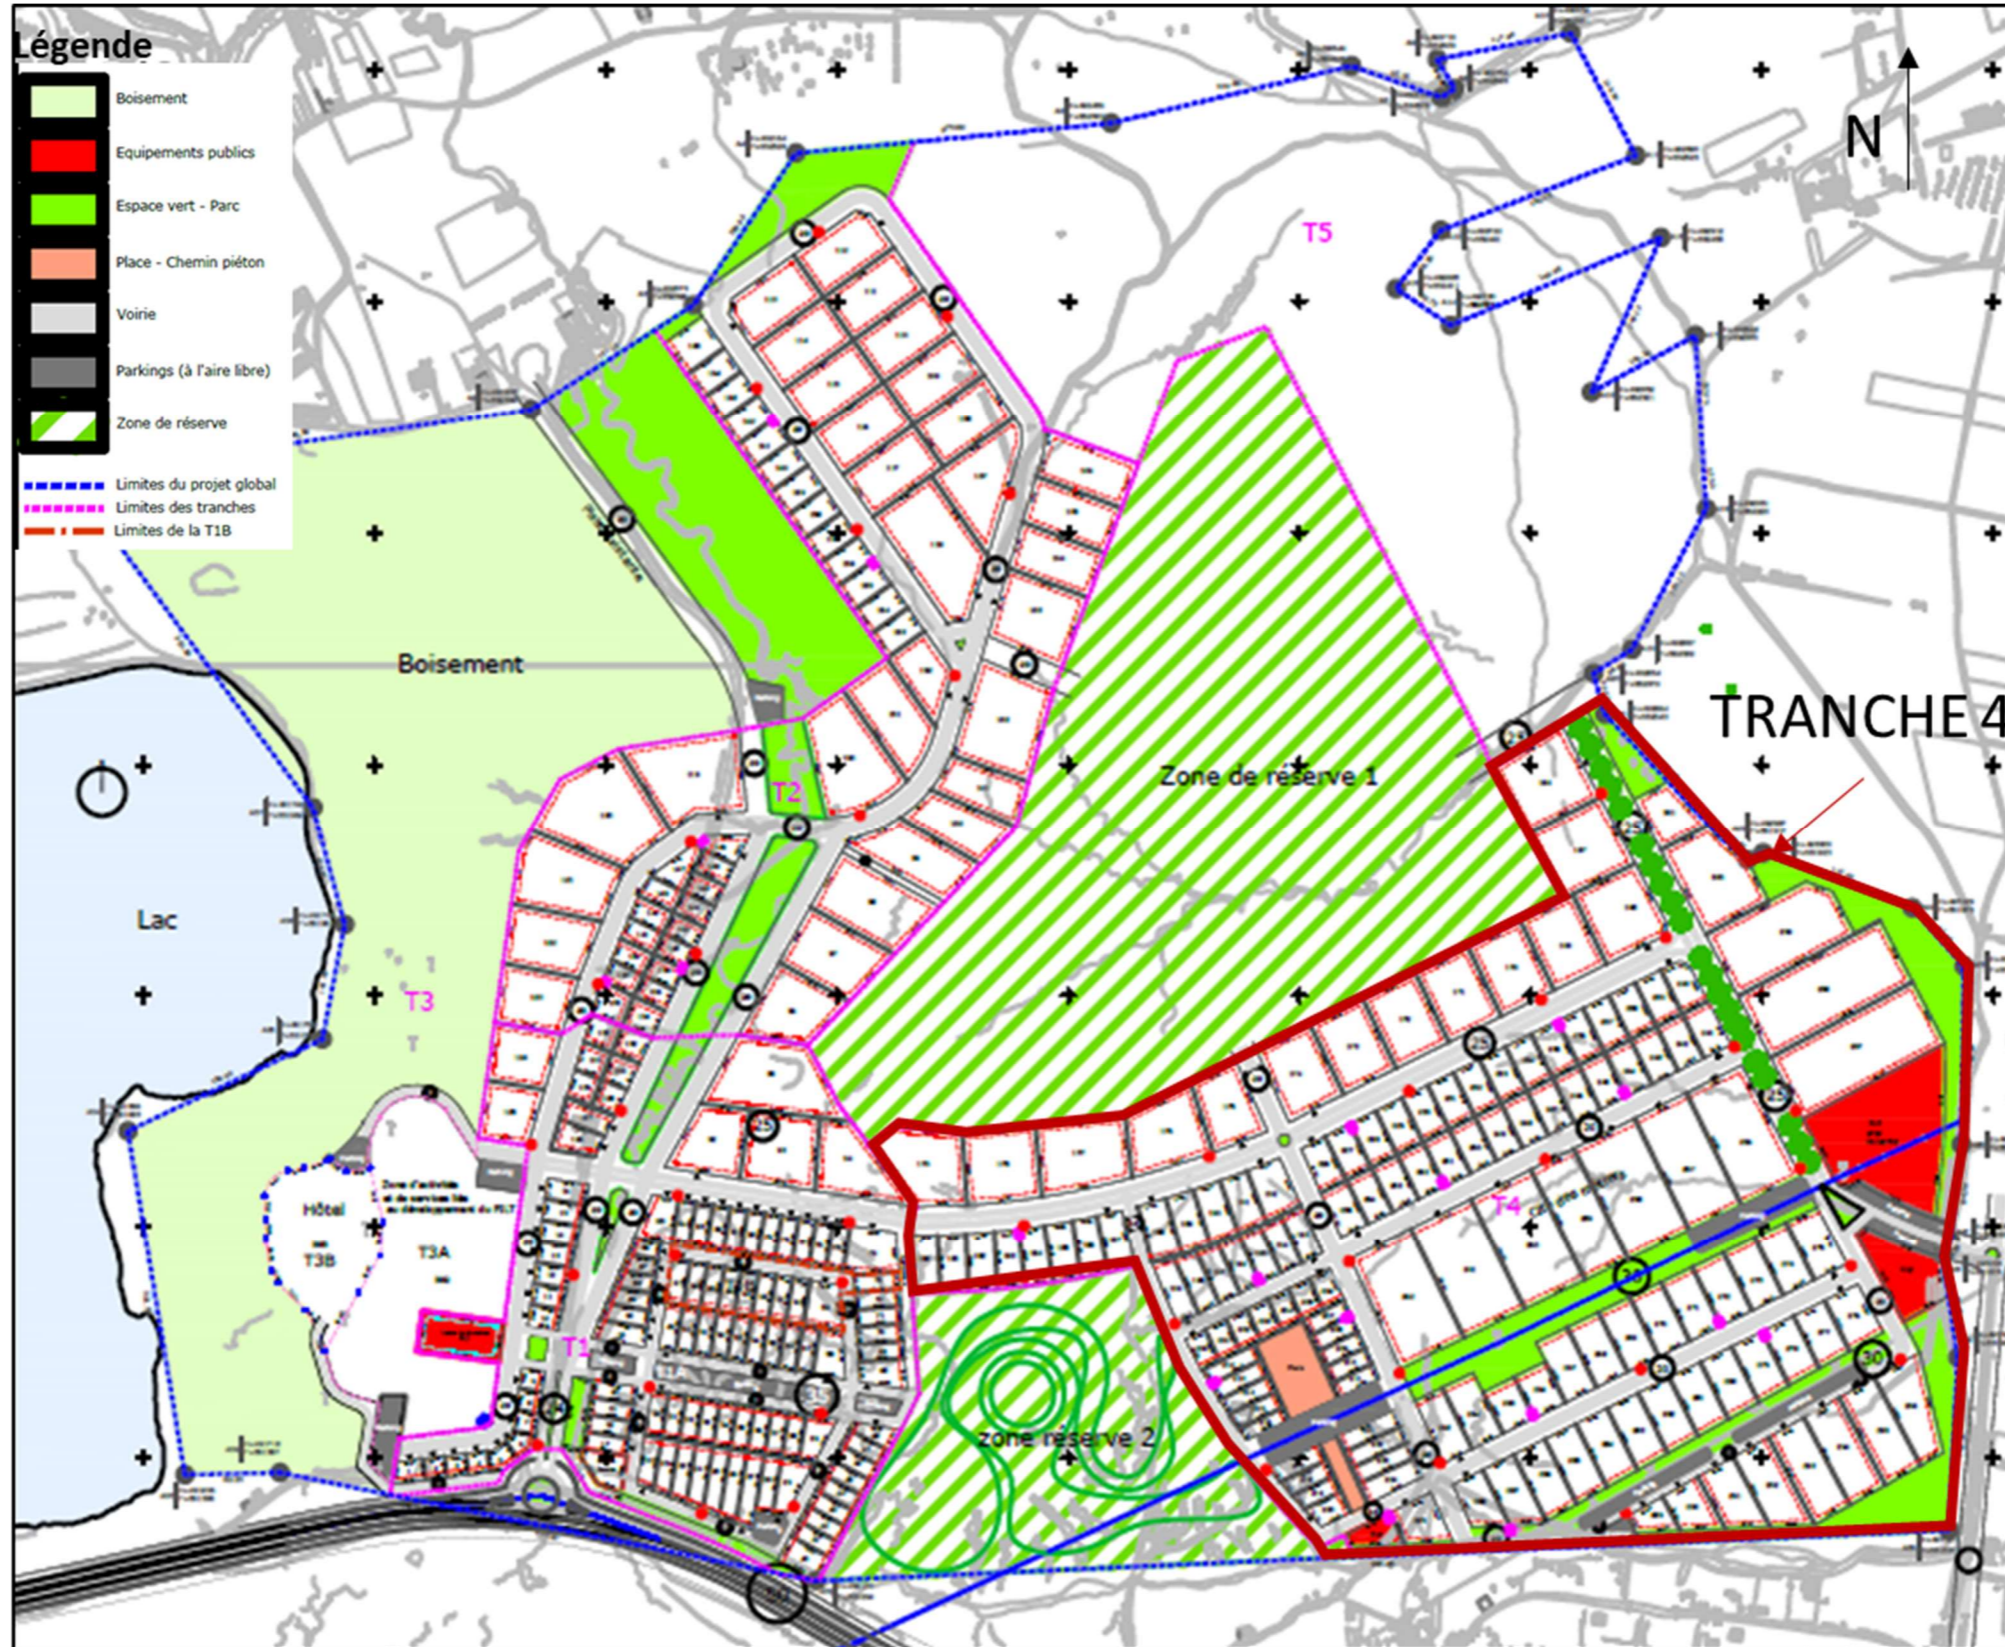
Plan de masse de la zone industrielle Tétouan Park
